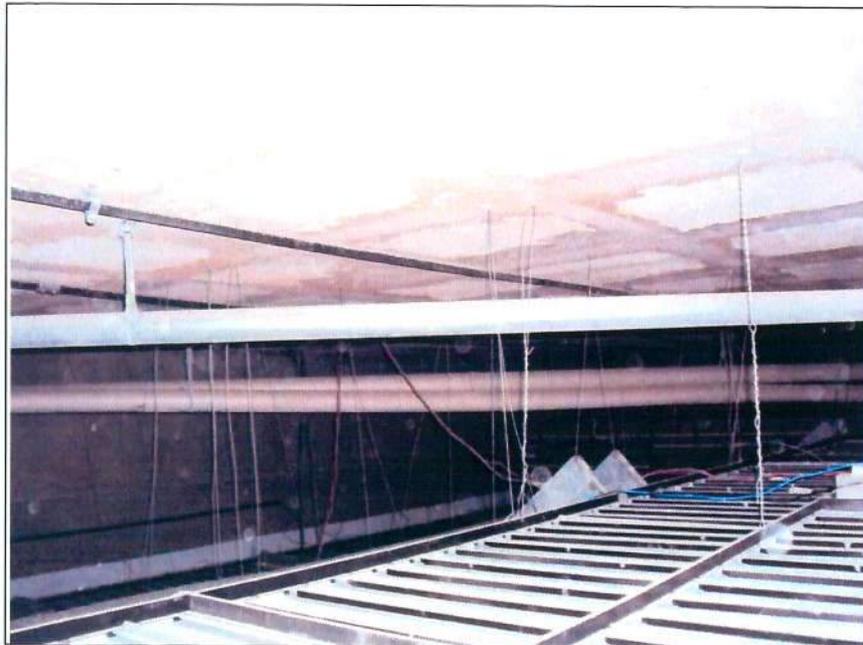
vestígios de infiltrações devido à fissuras localizadas próxima às janelas.
